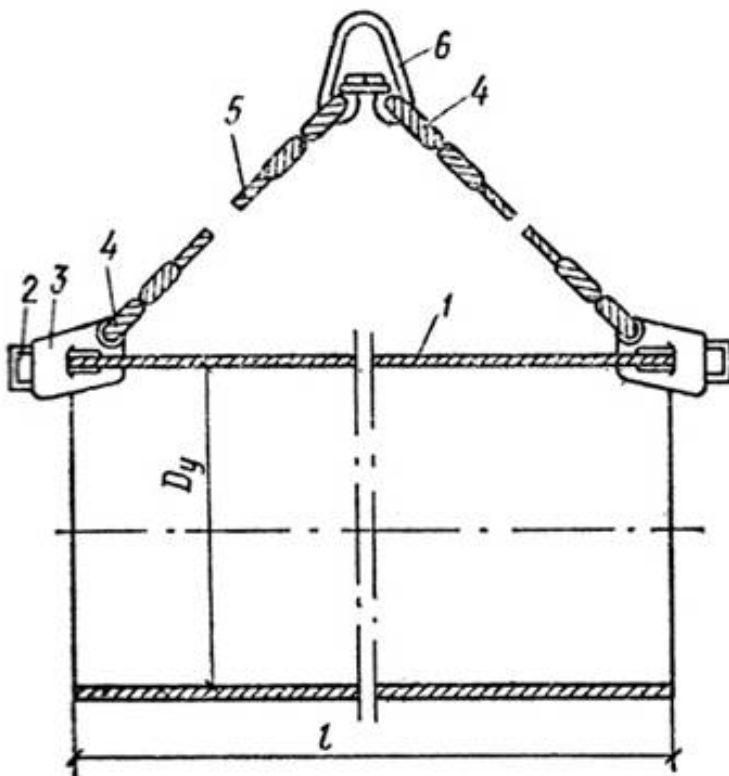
Торцевой захват: 1 – труба; 2 – скоба; 3 – захват; 4 – коуш; 5 – трос; 6 – серьга
